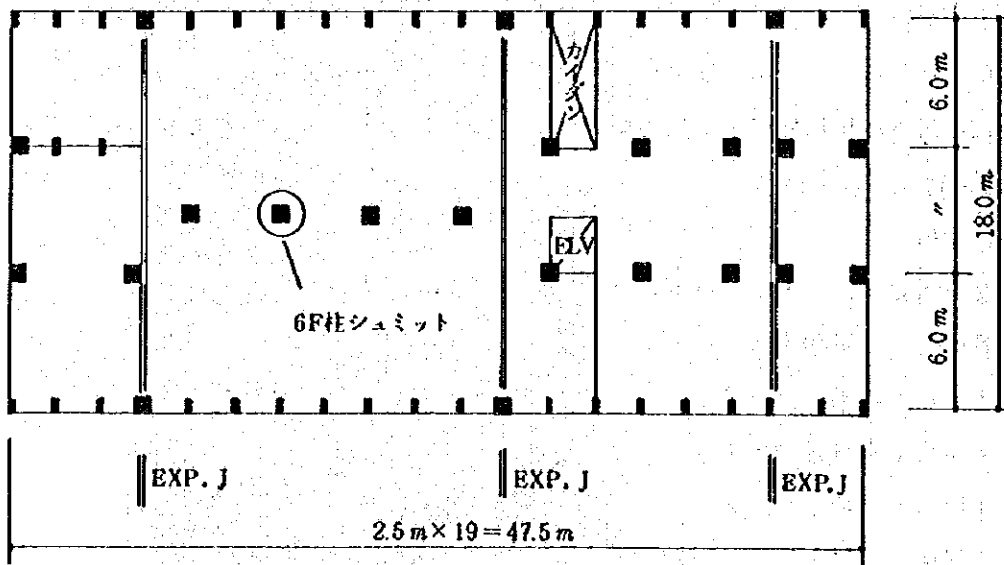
SEMPAC製粉工場平面図及び調査箇所
